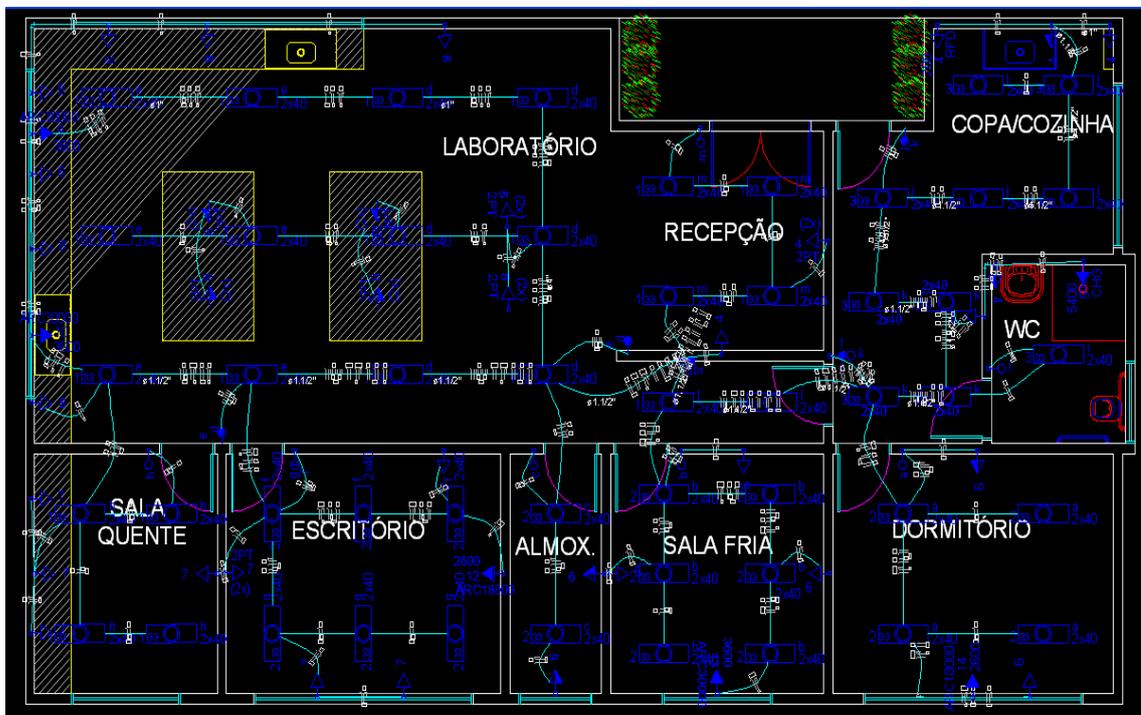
Planta baixa ao término do projeto elétrico Catolé
